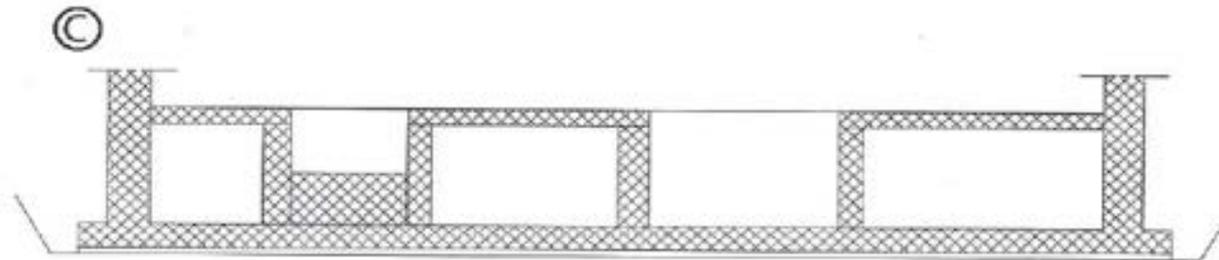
Beispiel einer Bauvereinfachung durch eine Wannenkonstruktion
